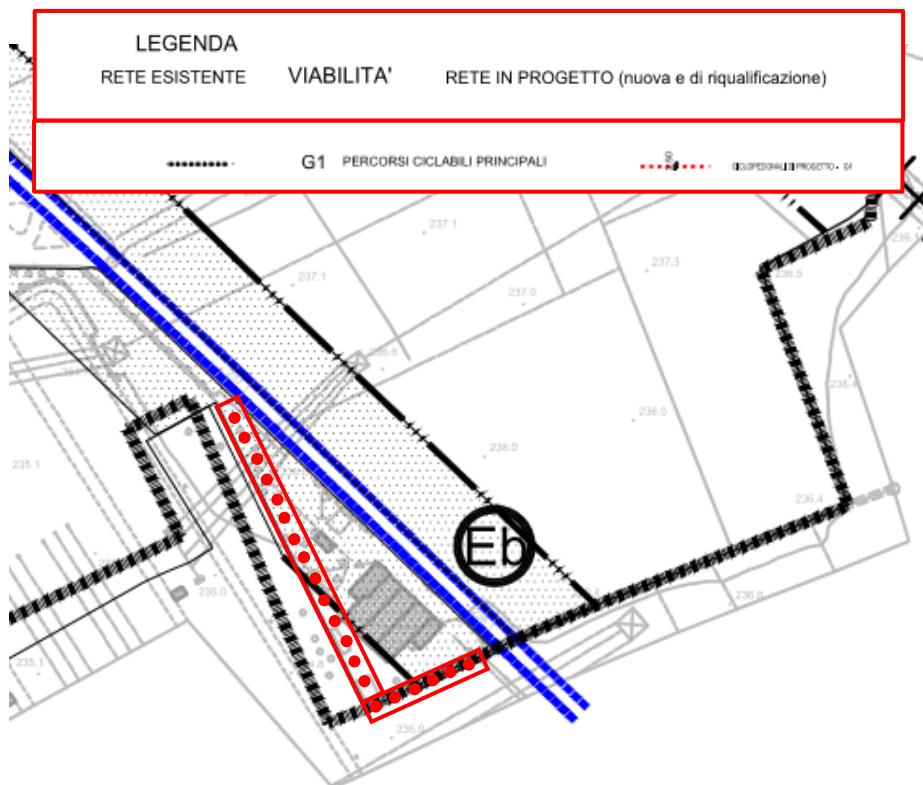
Stralcio planimetria “DOC N.1 – DOCUMENTO DI PIANO - B PROGETTO _allegato n°2: Viabilità” VARIANTE
